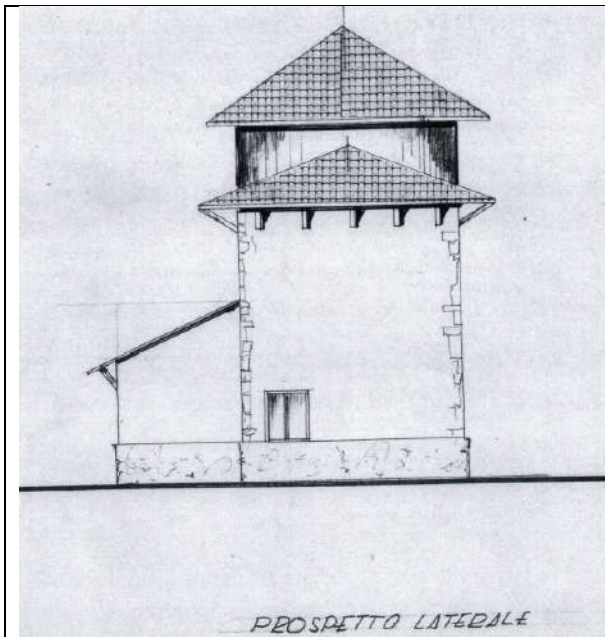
estratto dalla Licenza Edilizia n.2/1978 - prospetto laterale
